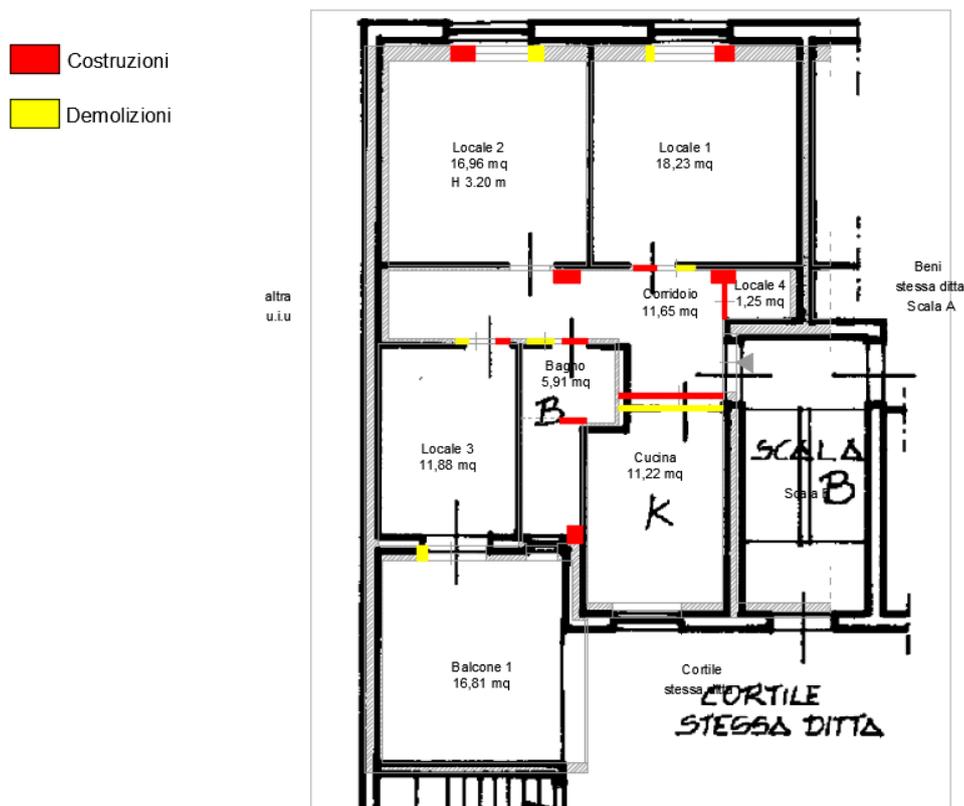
Confronto con planimetria catastale Foglio 4, p.la 1225, (sub. 7)
